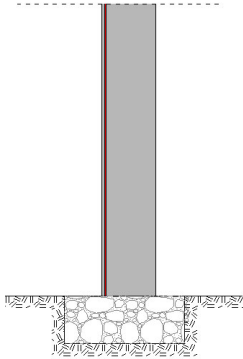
Zunchado camisa metálica. Rehabilitar con *acero.
